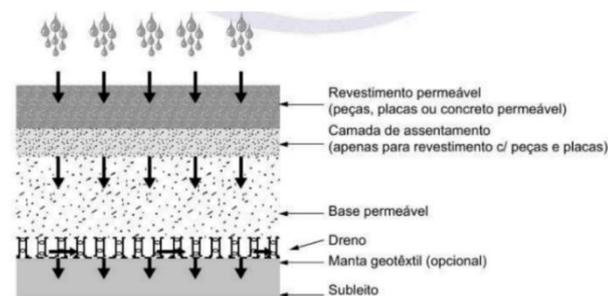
Exemplo de sistema de pavimento permeável com infiltração parcial. Fonte: NBR 16416 (2015).
